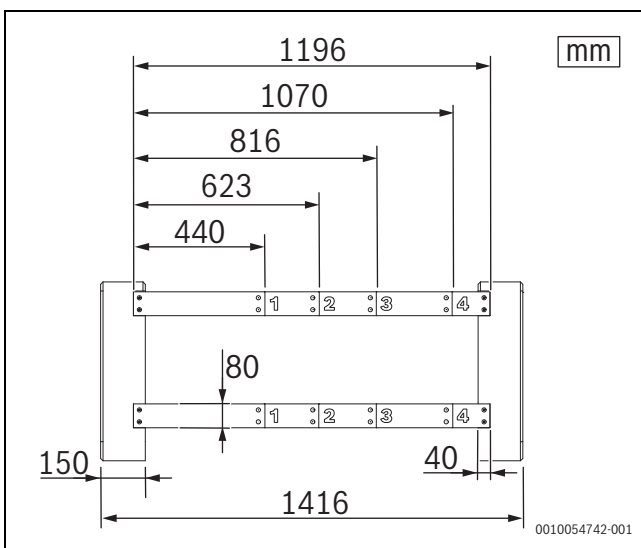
Abmessungen Fertigfundament (zusammgebaut)
